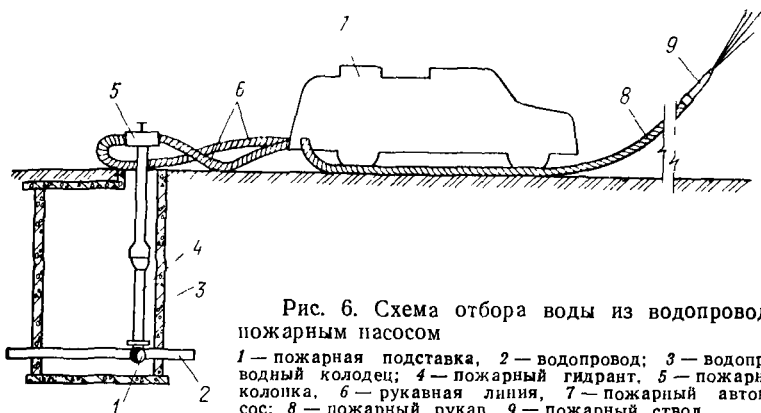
Схема отбора воды из водопровода пожарным насосом
